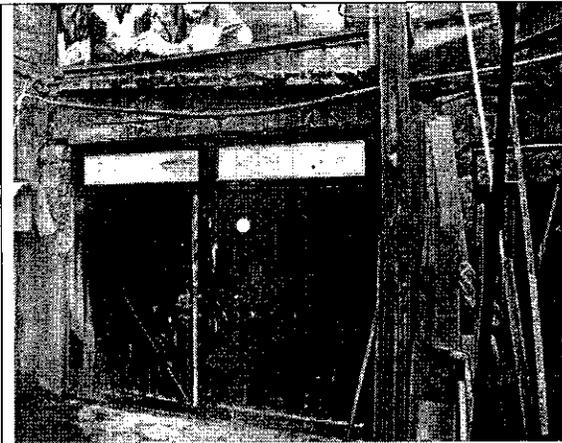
Vista de la cara interna (lateral norte) del muro de fachada, no se observan afectaciones estructurales importantes.
